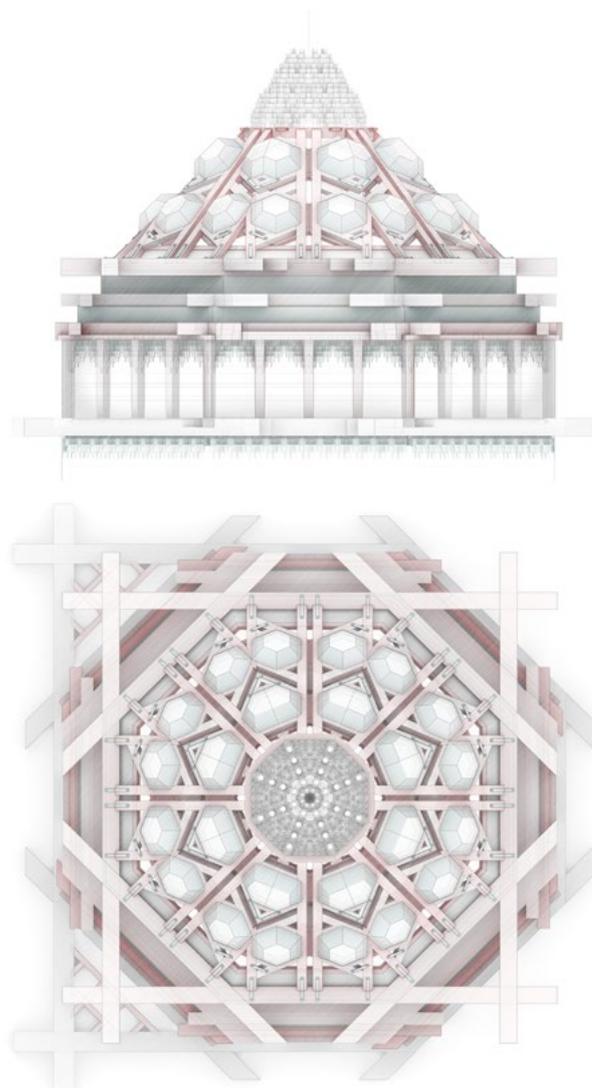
Planta y alzado del trasdós del artesonado de la capilla mayor. Incluyen los elementos ornamentales y estructurales.
